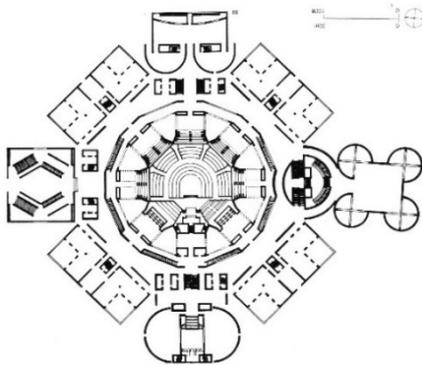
e 61 | Planta e volumetria da Assembleia de Dhaka [McCarter]
